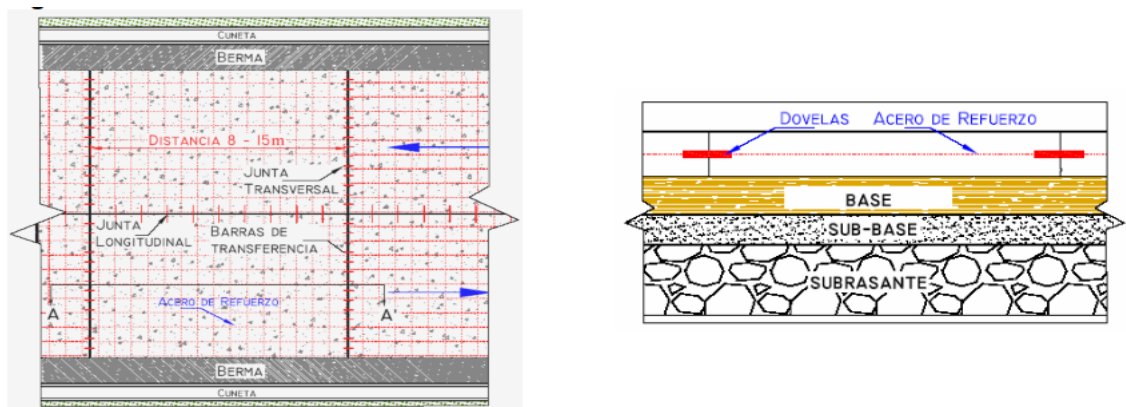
Vista en Planta y Perfil de la estructura de pavimento Rígido Reforzado con Pasadores
